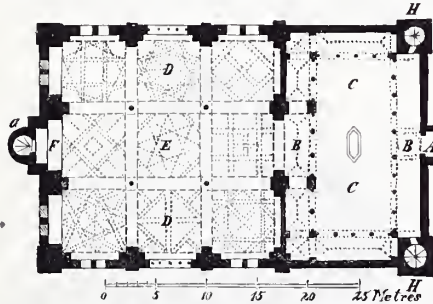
Grundriss einer Mesjida in Toledo.
